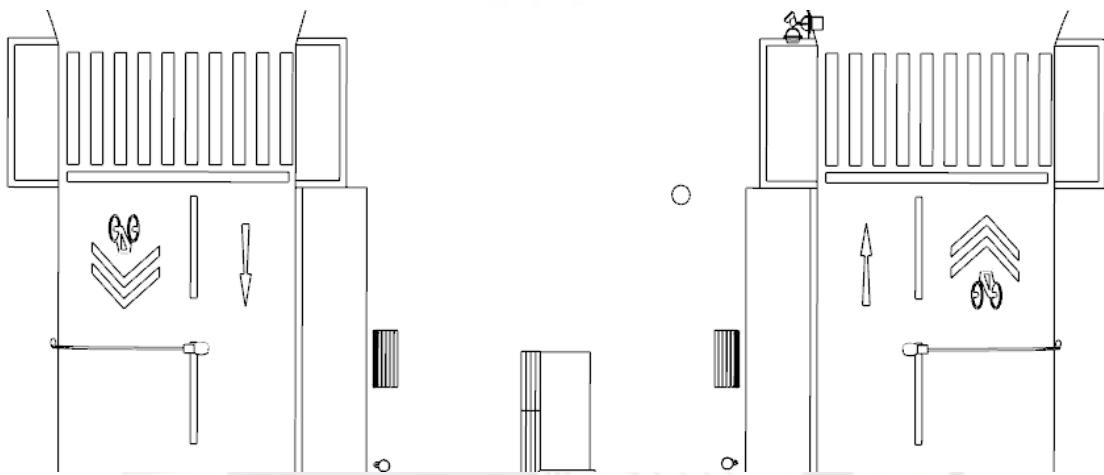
Redimensionamiento de veredas y calzada de la Av. Palermo - Planta. Fuente: Elaboración propia
